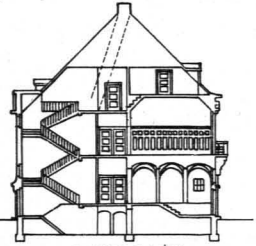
ANSICHTEN, GRUNDRISSSE UND LAGEPLAN.
